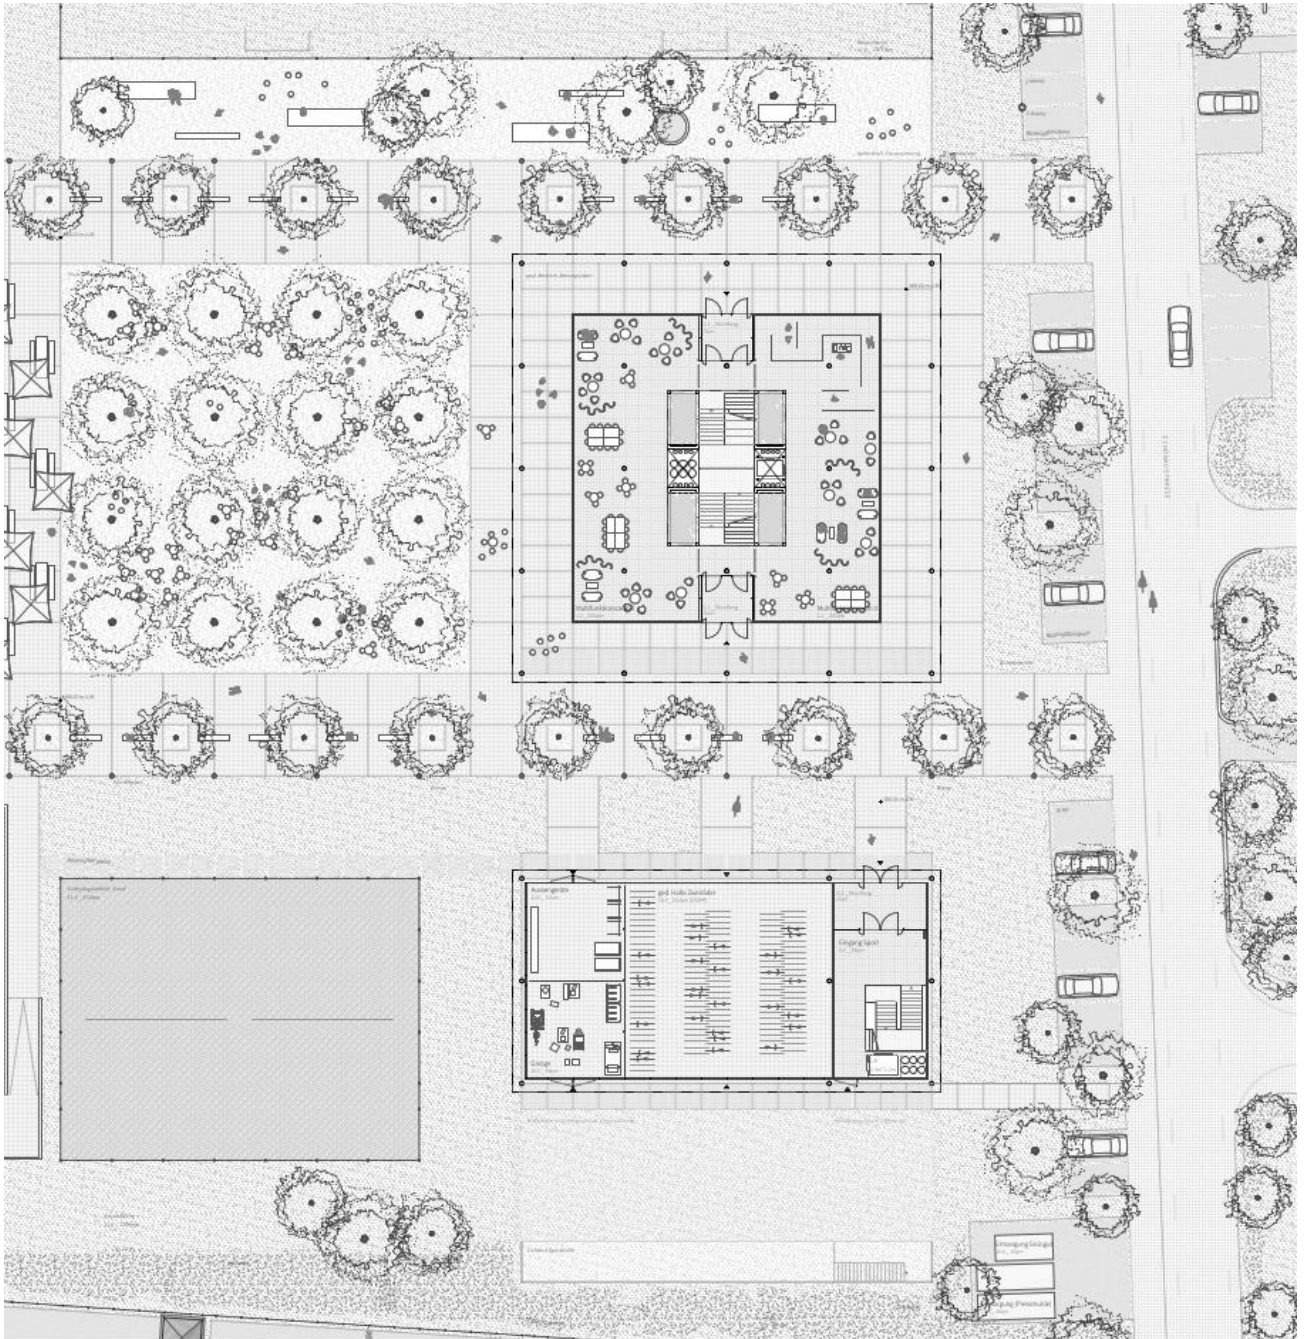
Erdgeschoss mit Neubau, Nebenbau und zentralem Aussenbereich gegen den Bestand (ohne Massstab).
